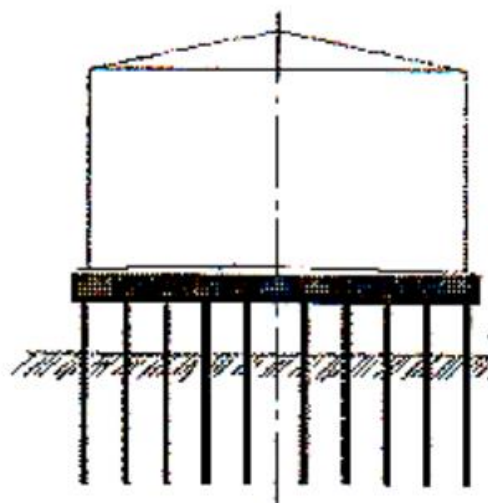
Теплоизолирующая подушка на свайном фундаменте [23]
